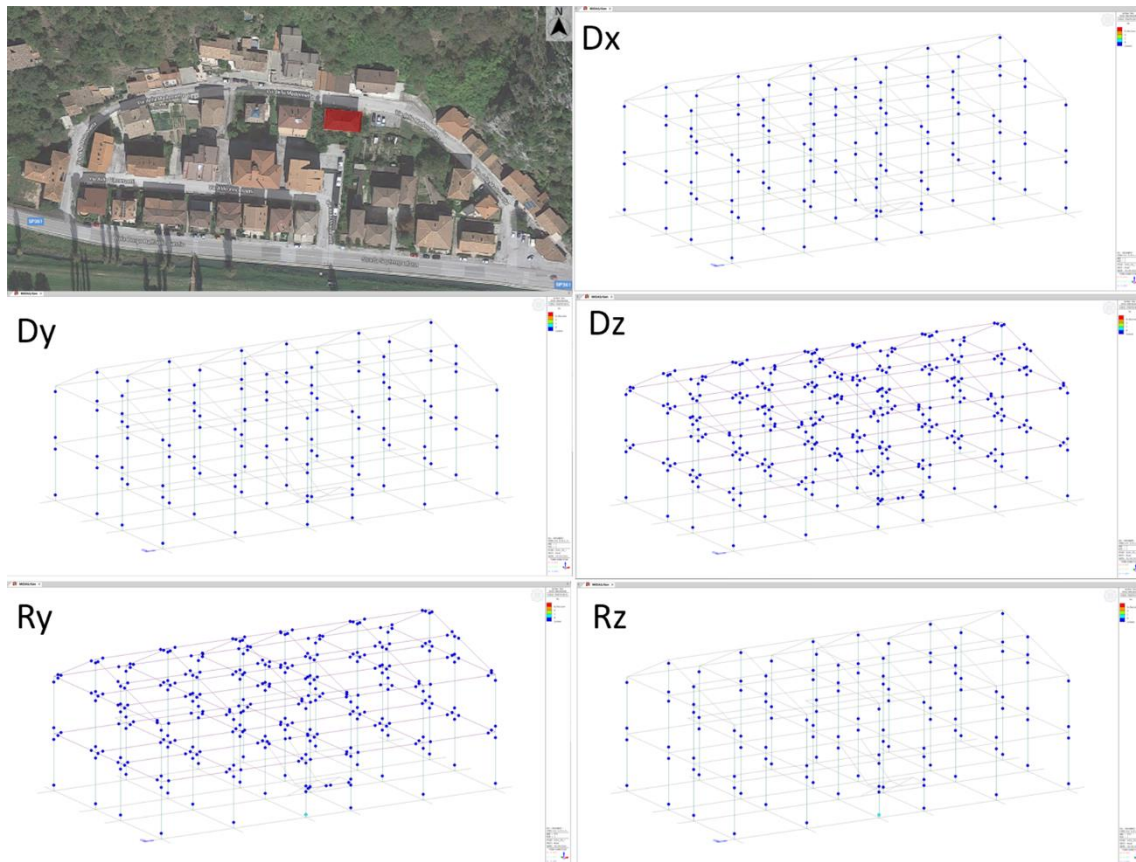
Cedimento fondale applicato ad un edificio in acciaio a due piani con trave rovescia nella POSIZIONE 3 all'interno del quartiere "Madonnetta" del comune di Pioraco.
